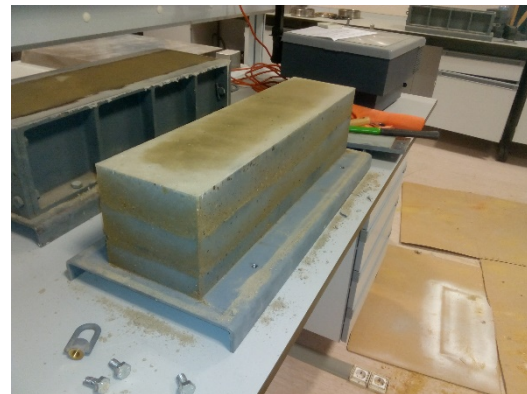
Aspecto de la probeta prismática confeccionada y desmoldada. Fuente: propia
